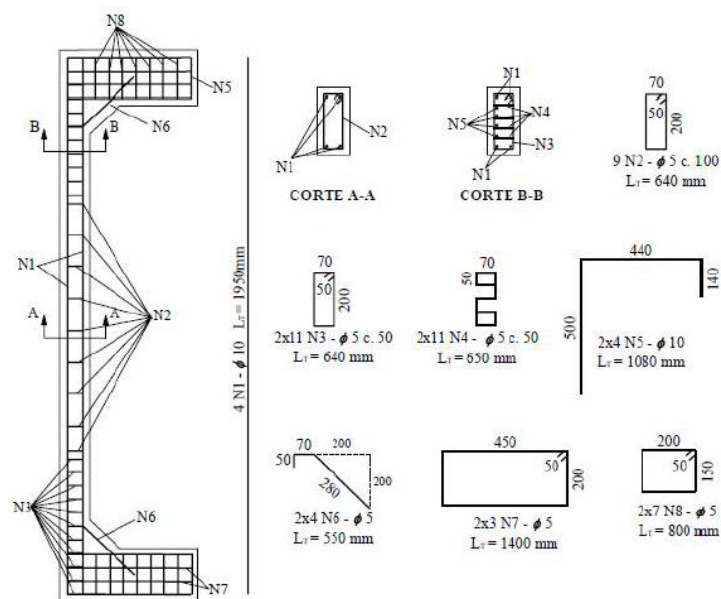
Detalhamento das armaduras da Série PCA4 (ADORNO, 2004)
